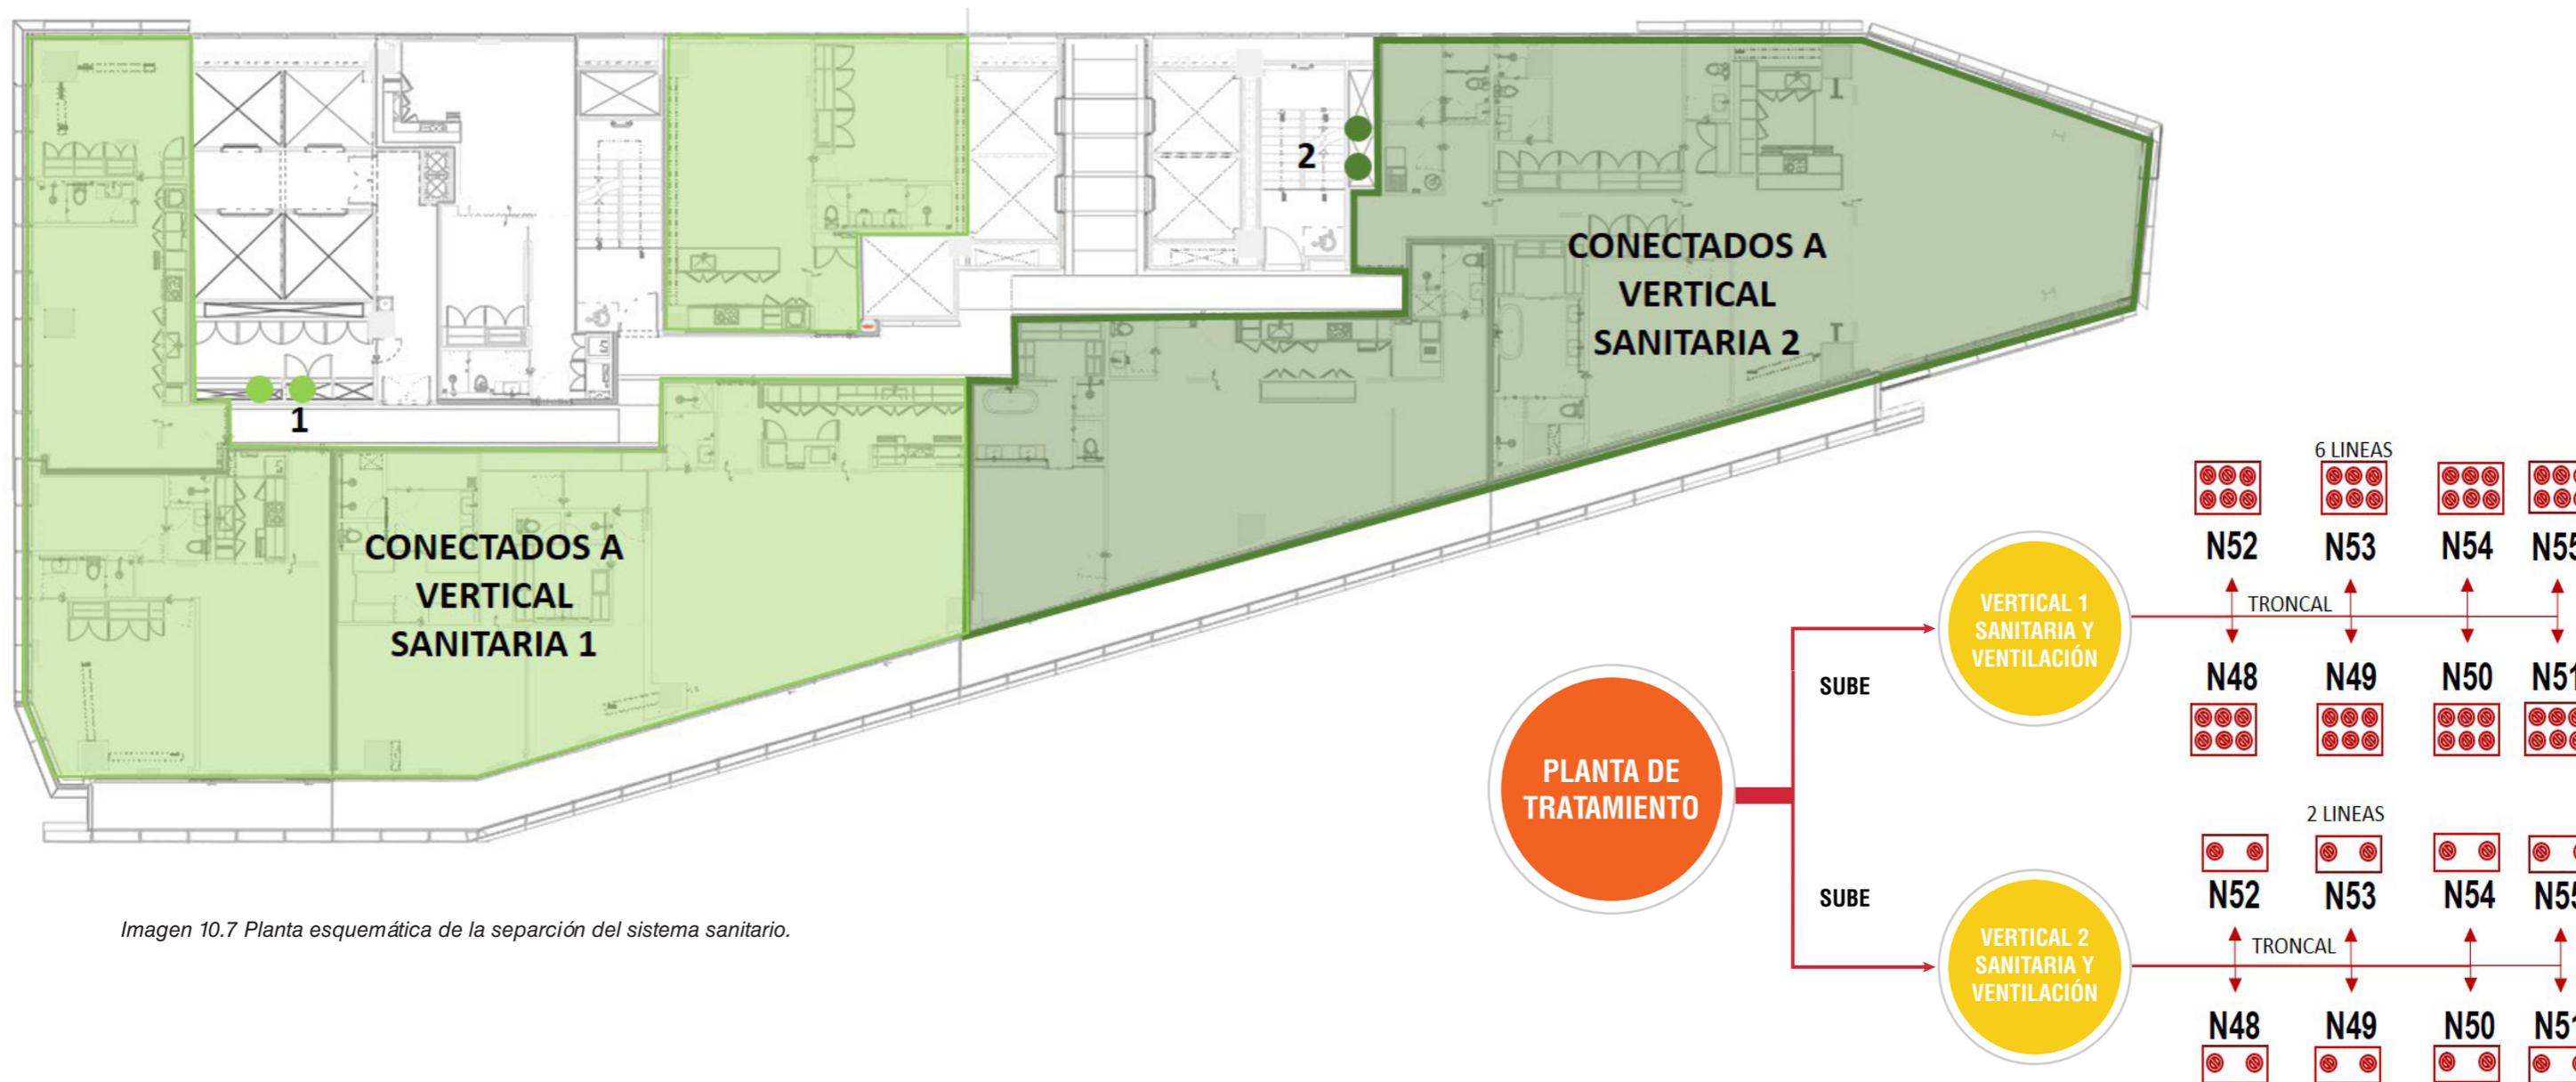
Planta esquemática de la separación del sistema sanitario.
